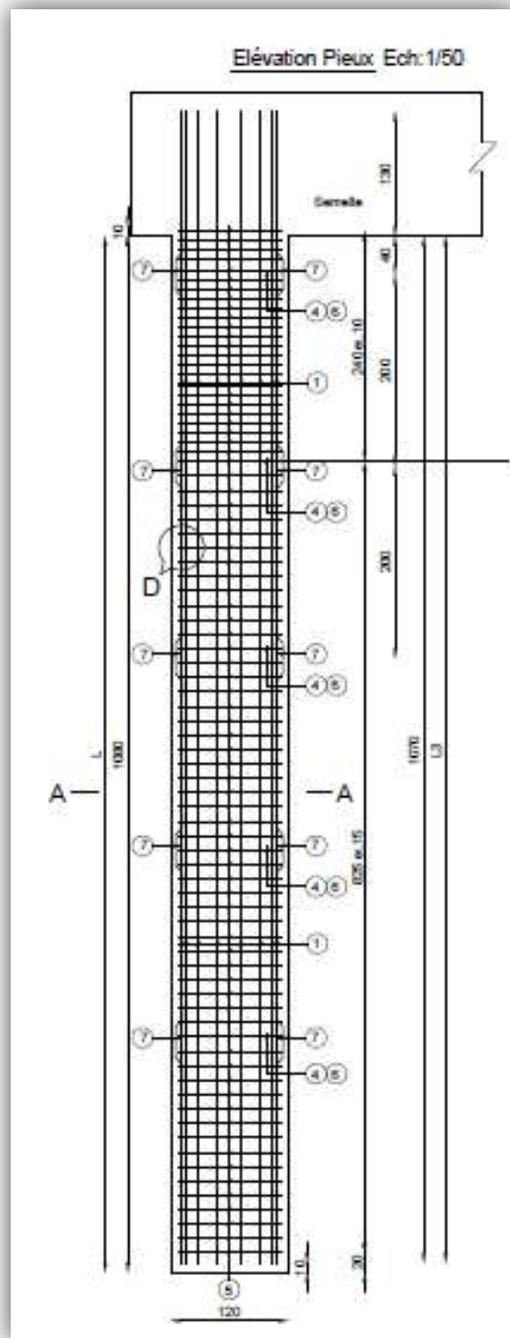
Détails du ferrailage d'un pieu d'une pile [3]
